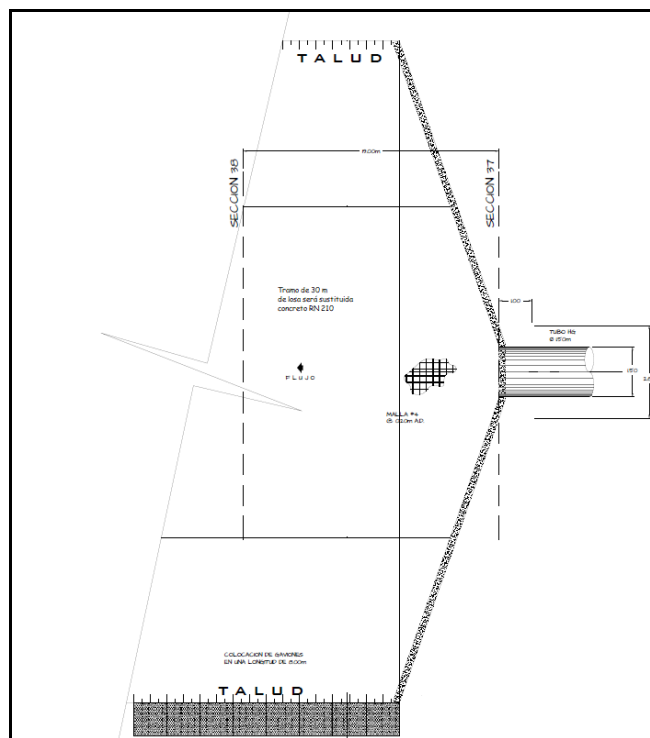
Vista superior de transición a la salida de puente canal n°5. Modificado de SENARA, 2020
